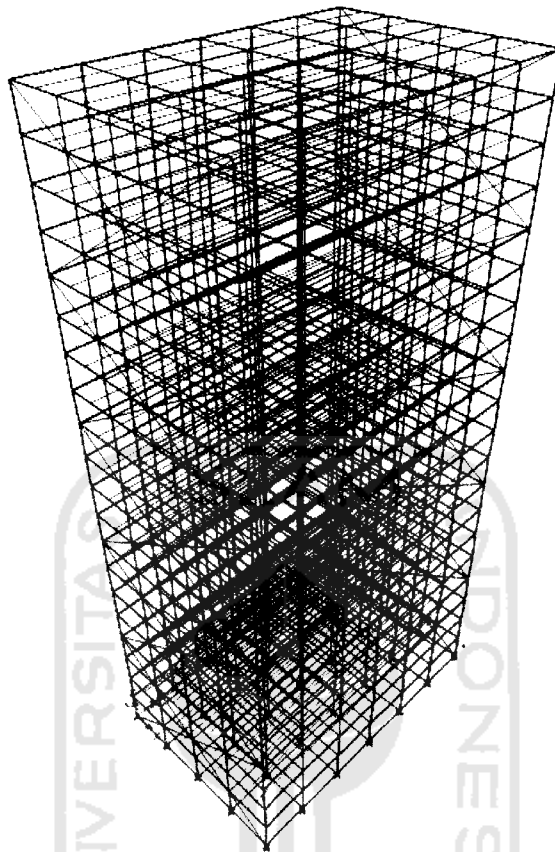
Denah struktur baja 20 lantai memakai *outrigger* dan *belt truss
